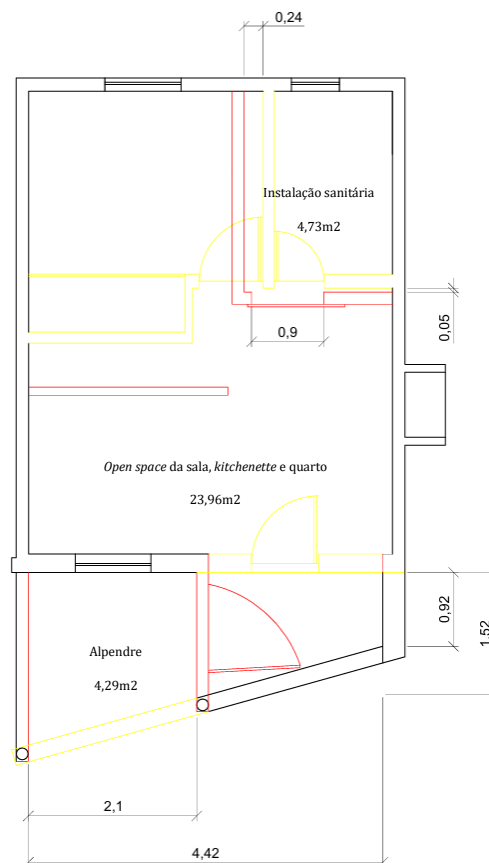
Planta de Alteração - Bungalow 1 (Fonte: autora)
